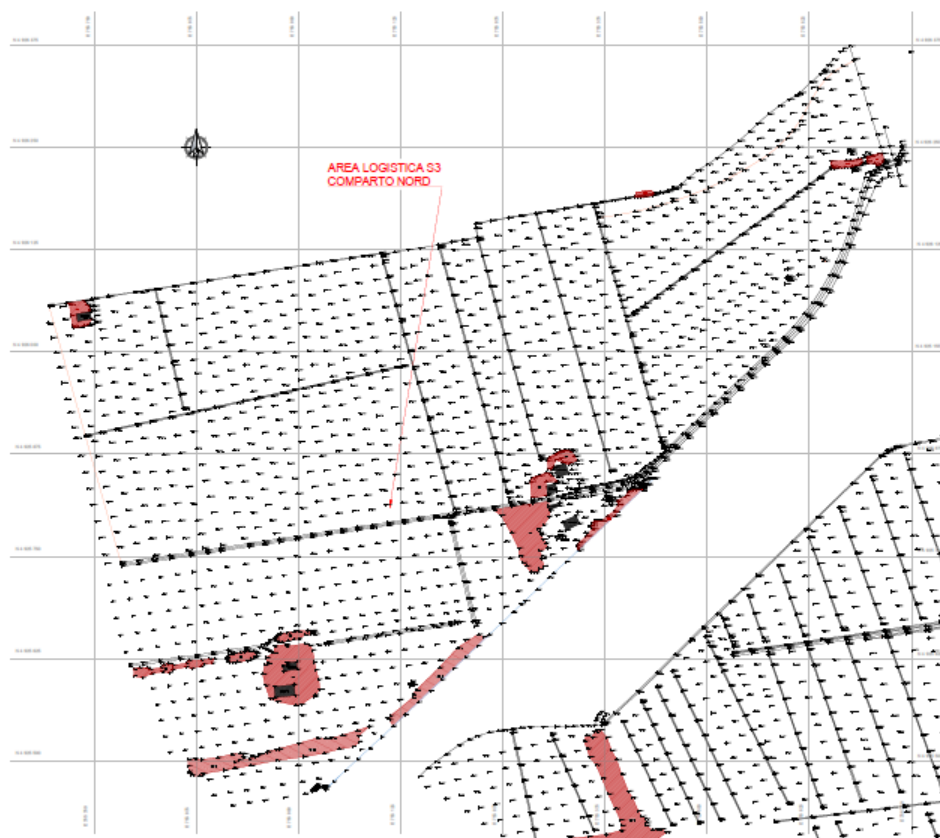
Area Logistica S3 Nord – Planimetria di Rilievo
